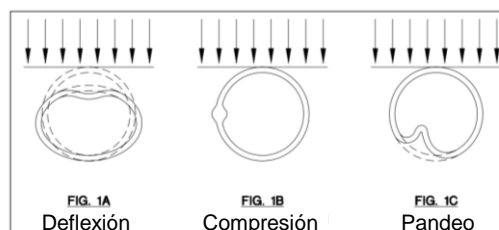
Mecanismos de fallas tuberías flexibles (Handbook Pipe of PE, 2007).
